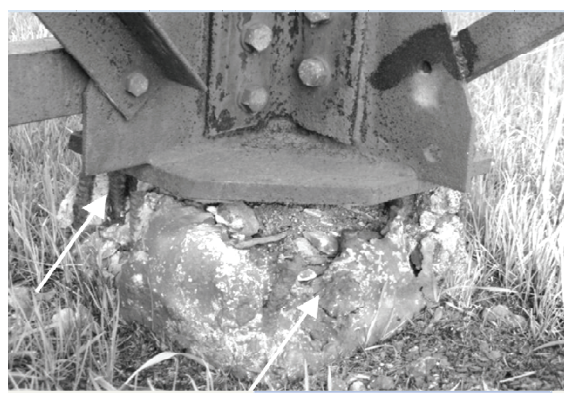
Разрушение защитного слоя бетона фундамента, оголение и коррозия арматуры, анкеров.
